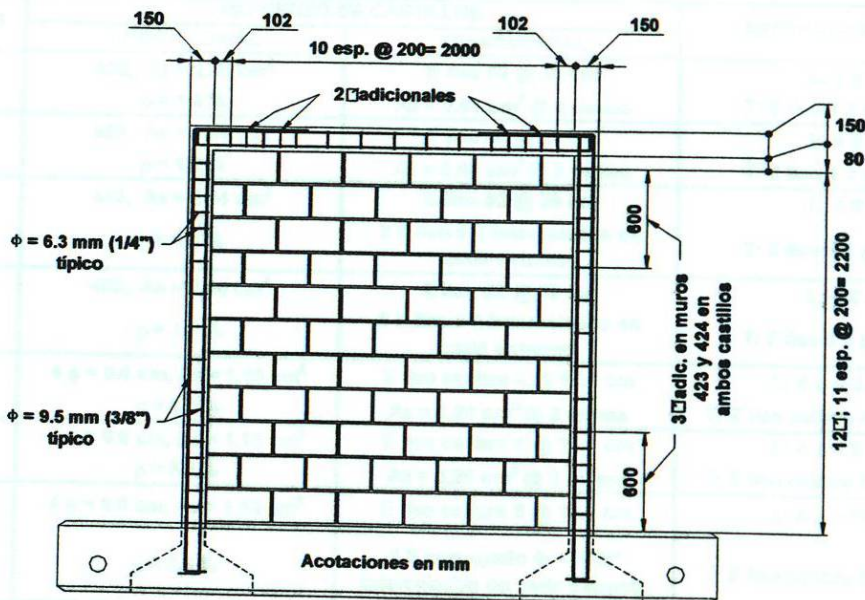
Armado de muros: 421, 422, 423 y 424
